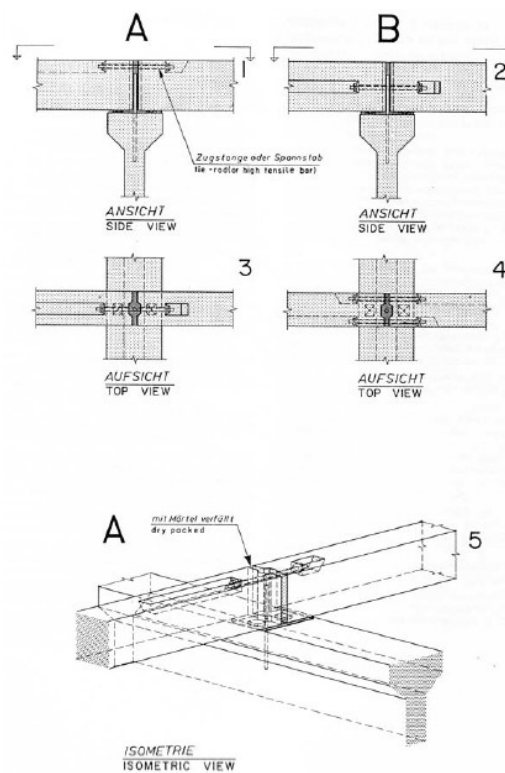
Ligação por barras de pré-esforço (Stupré, 1981)
